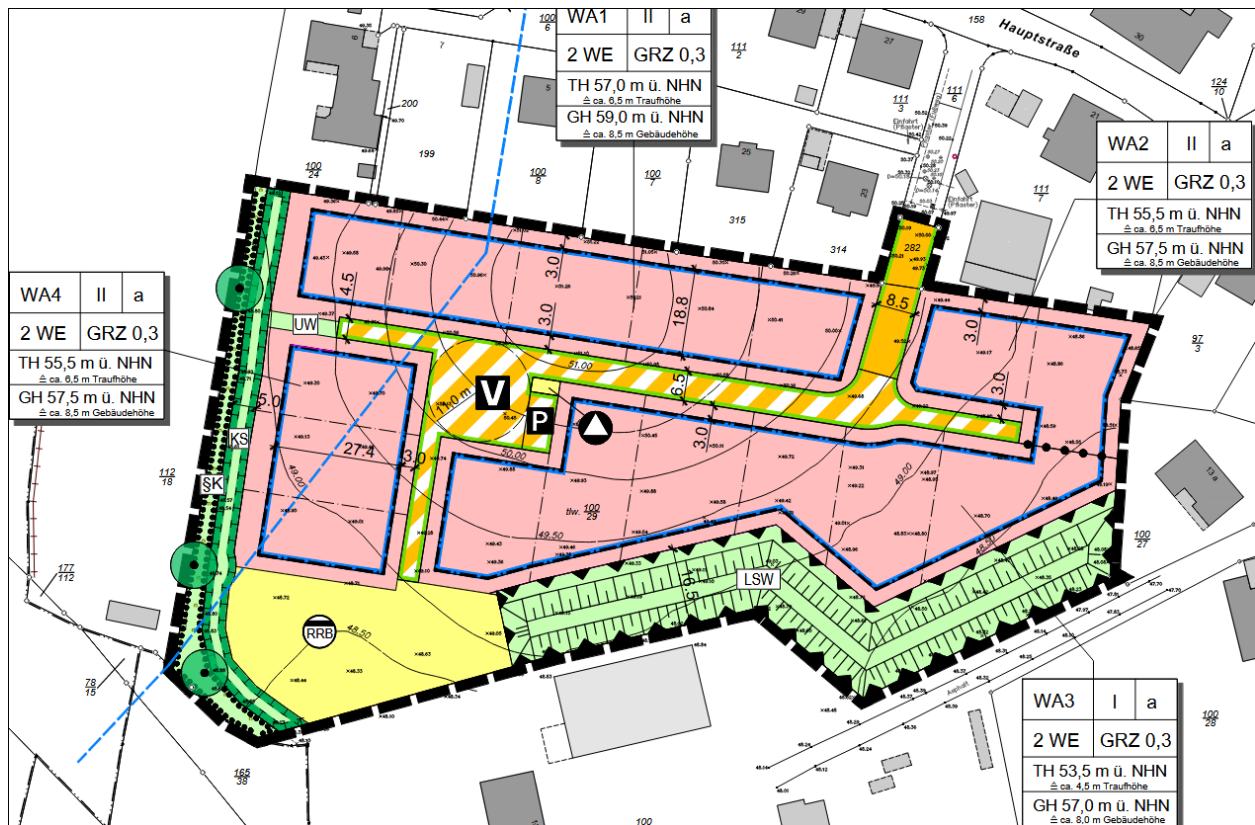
Gemeinde Einhaus Bebauungsplan Nr. 7 – Planzeichnung, rot: geplantes Wohngebiet, blau: Baugrenzen, grün: Gehölze und Lärmschutzwall, gelb: Regenrückhaltebecken, orange/weiß: Verkehrsflächen (Ausschnitt aus PROKOM GmbH Feb. 2024)
